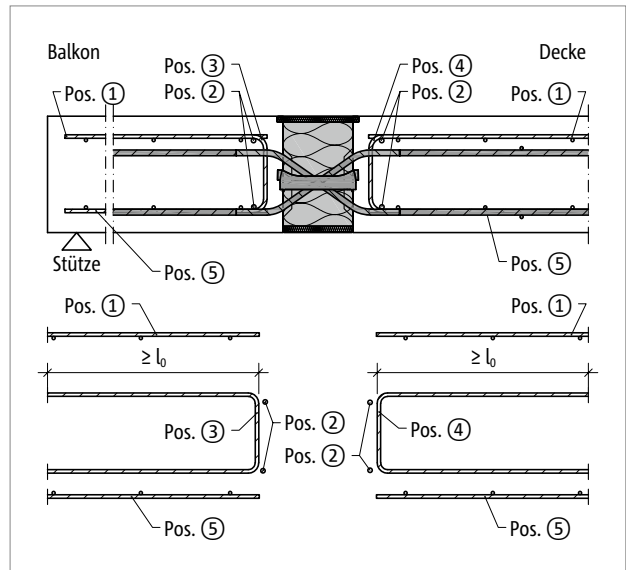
Schöck Isokorb® XT Typ QL-VV5 bis VV11 Bauseitige Bewehrung
